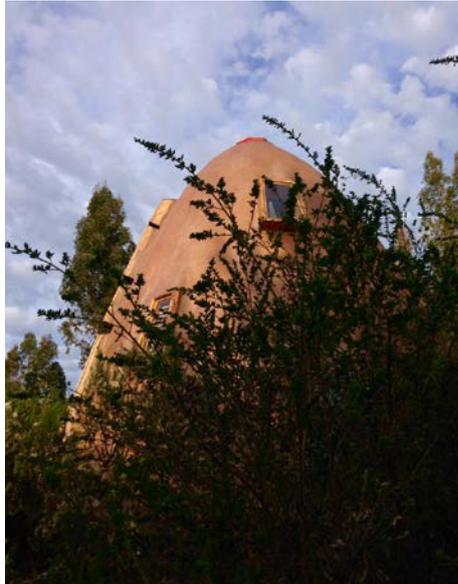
Estado exterior actual del proceso constructivo, con la imprimación de sellante para albañilerías
